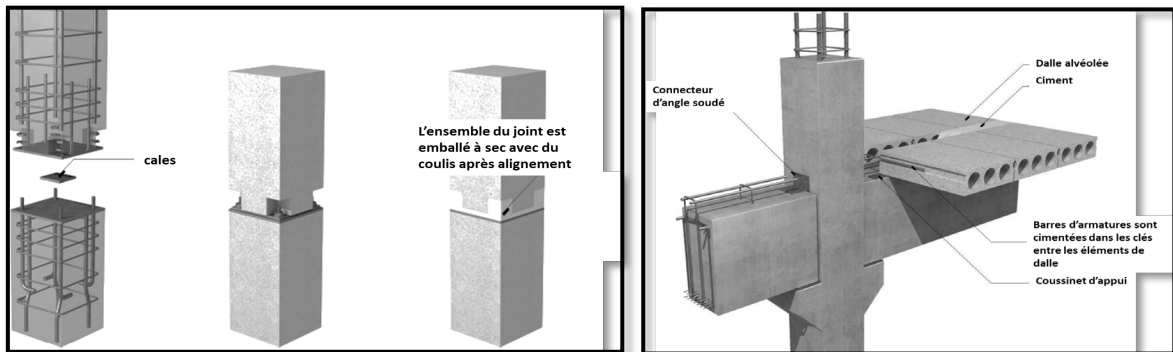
assemblage deux poteaux (Connections s.d.) Figure 114 assemblage des dalles (type-de-connexion s.d.)
